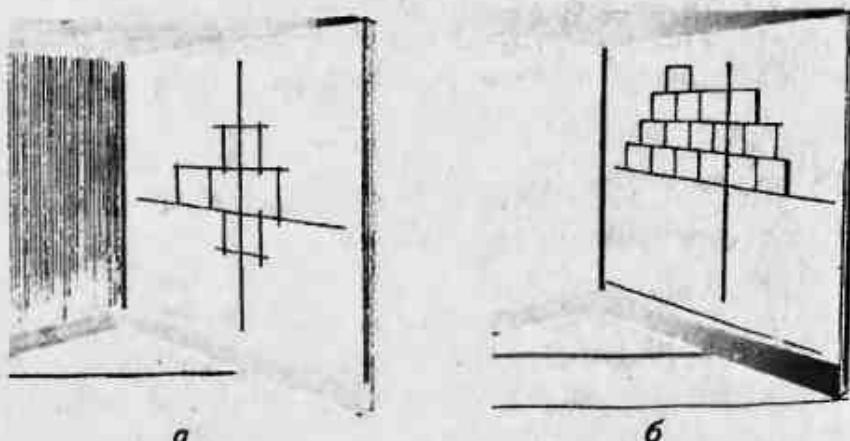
Облицовка стен плиткой из пробки: а — начало установки; б — установка первого и последующих рядов
